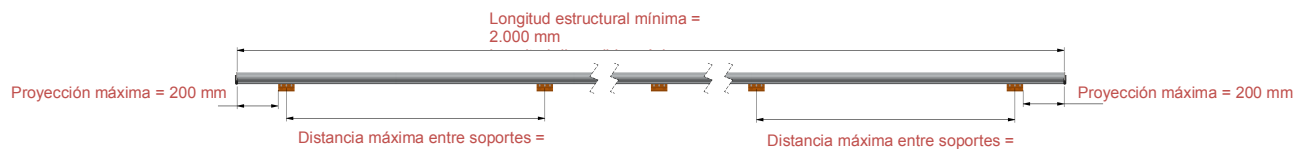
Estructura esquemática Rope Access de carriles individuales
